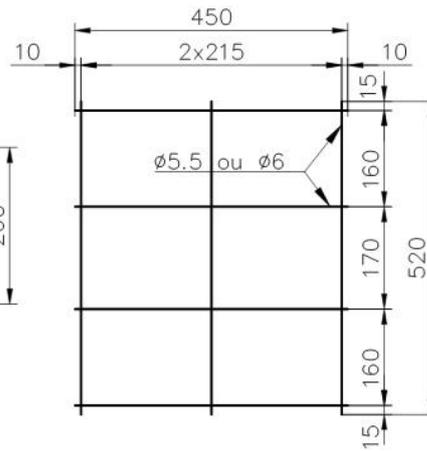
caniveau à câbles standard modèle 22 avec couvercle (dimensions en mm)
